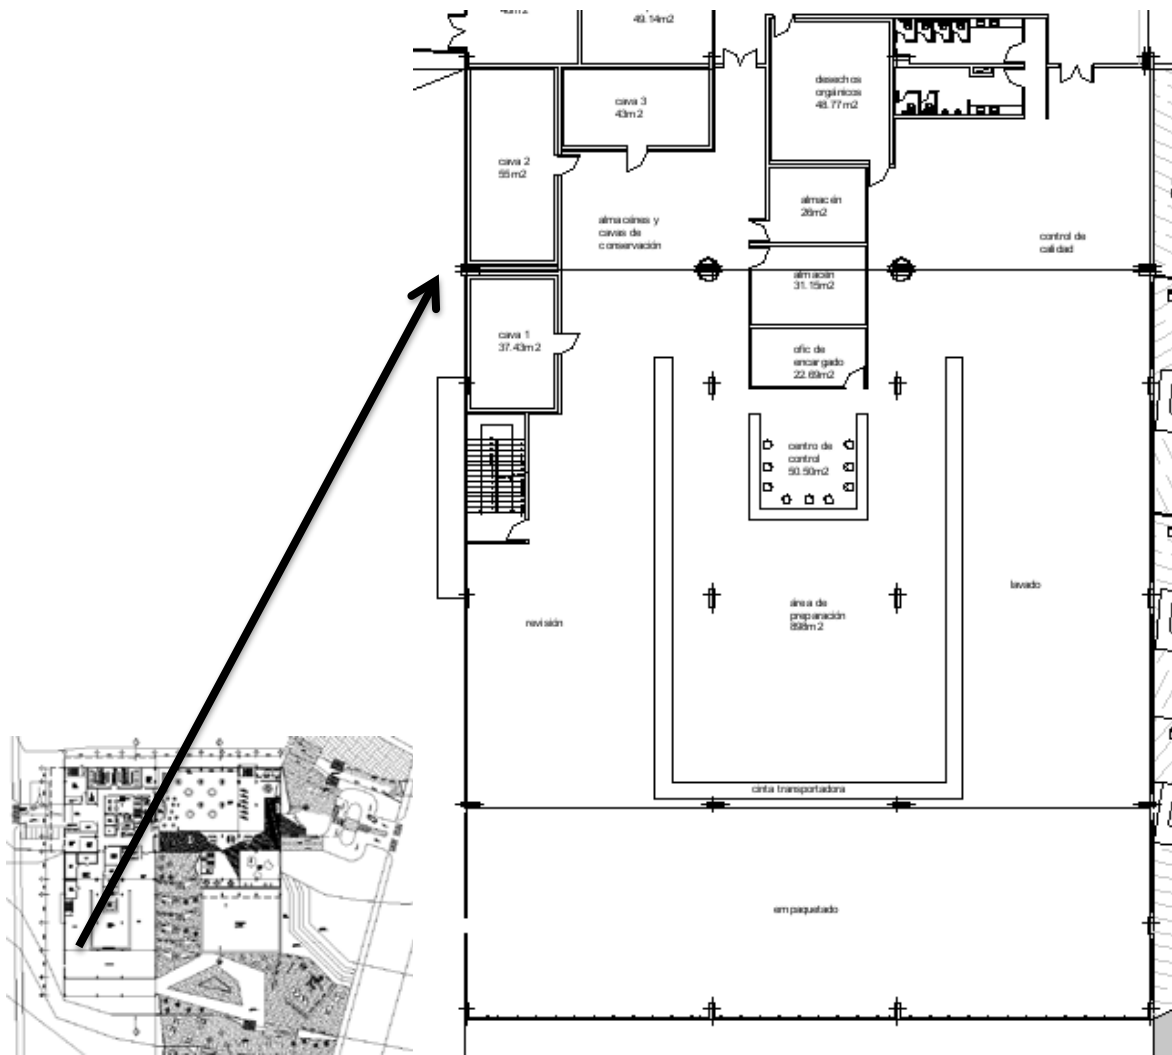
Planta Baja nivel +/-0.00m, Área de preparación. (2017).
